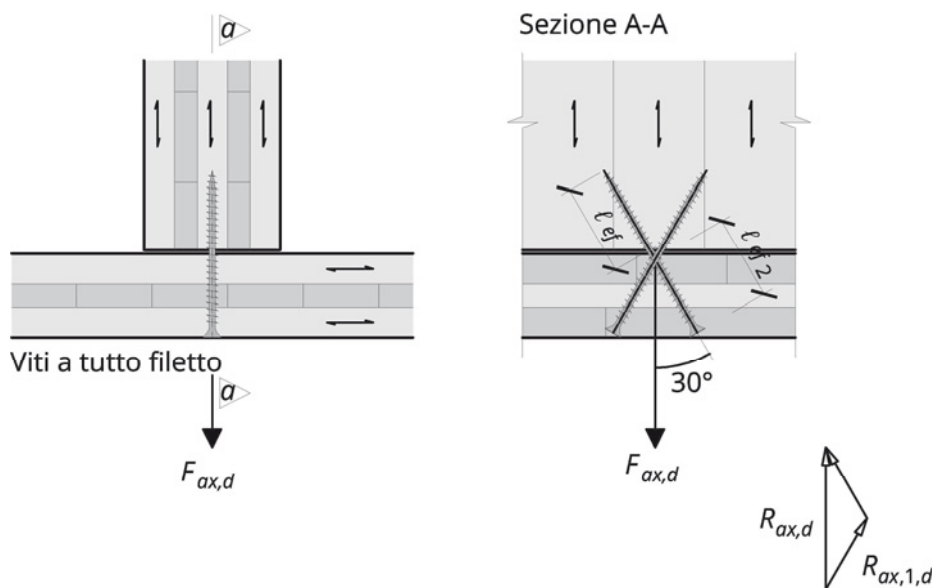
Sospensione tramite viti a tutto filetto parallele al piano della parete
